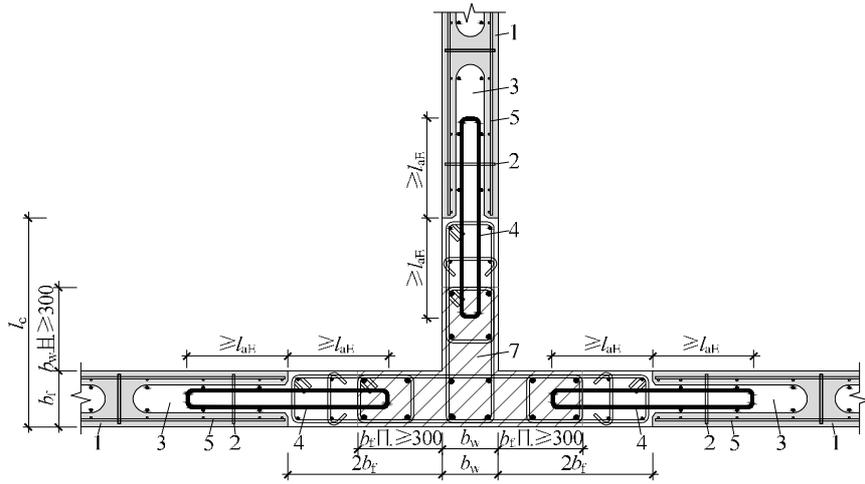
约束边缘构件区非边缘空心墙板水平连接构造示意
